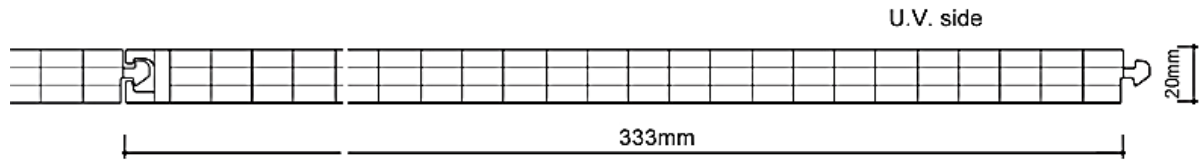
Dibujo en planta de una placa para sistemas machihembrados. En la ilustración se aprecian los machihembrados. En este caso se muestra la placa arcoPlus 324 de la empresa dot.gallina. [Extraída de: <http://www.gallina.it>]
